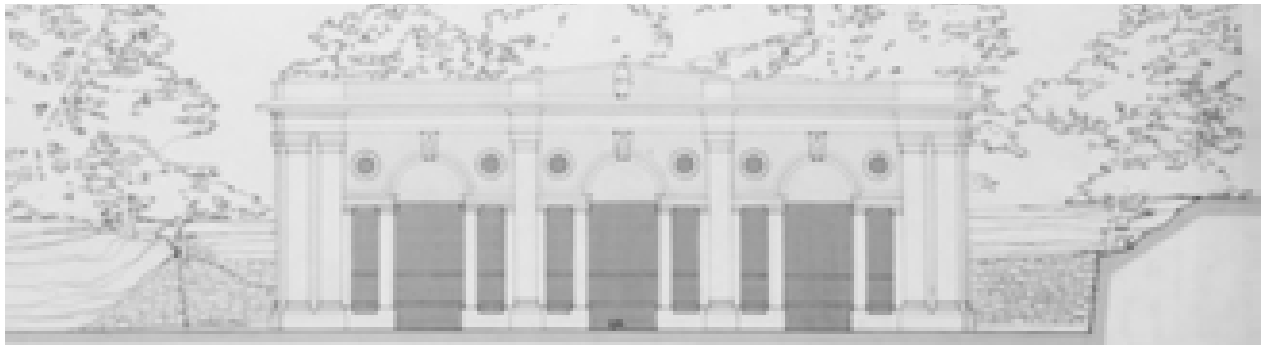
Prospetto Sud stato attuale, progetto concessionato il 15/01/1985 (AABS-899)
